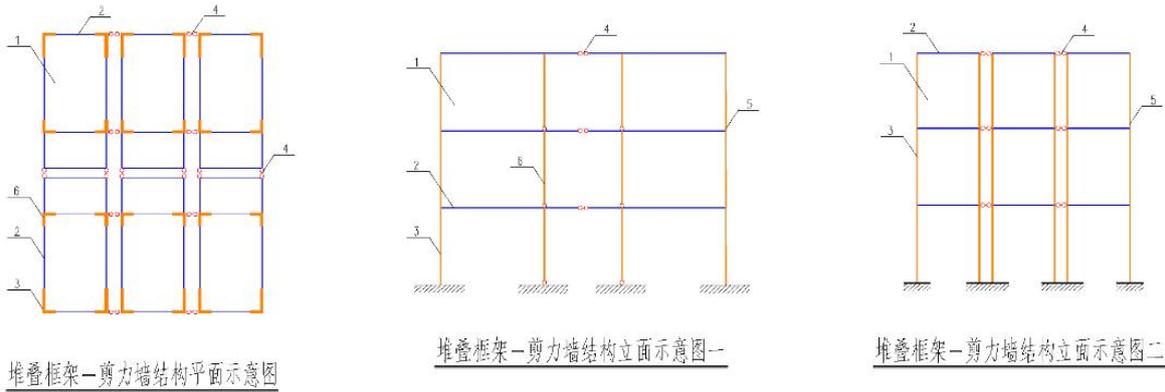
堆叠框架-剪力墙结构平立面示意图
